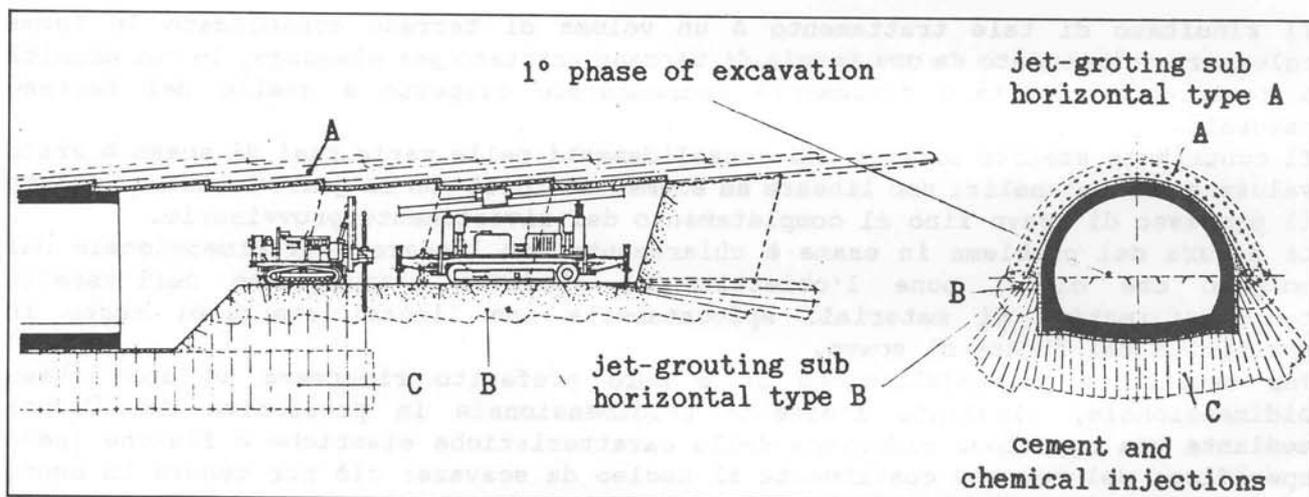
Avanzamento lavori dalla mezza sezione.
